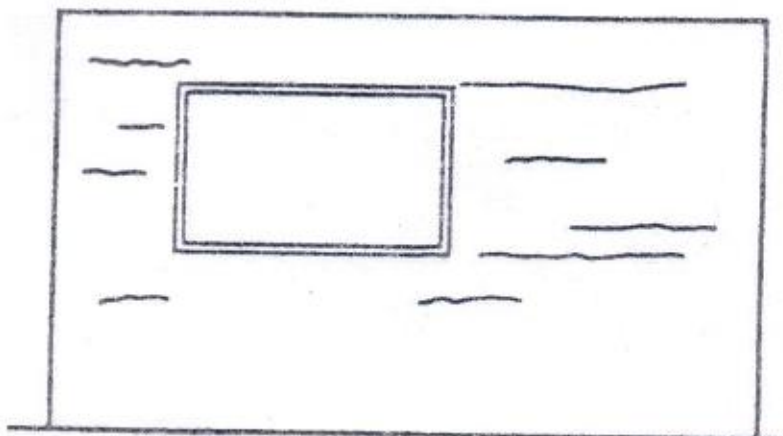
Fissuras horizontais no revestimento provocadas pela expansão da argamassa de assentamento.
